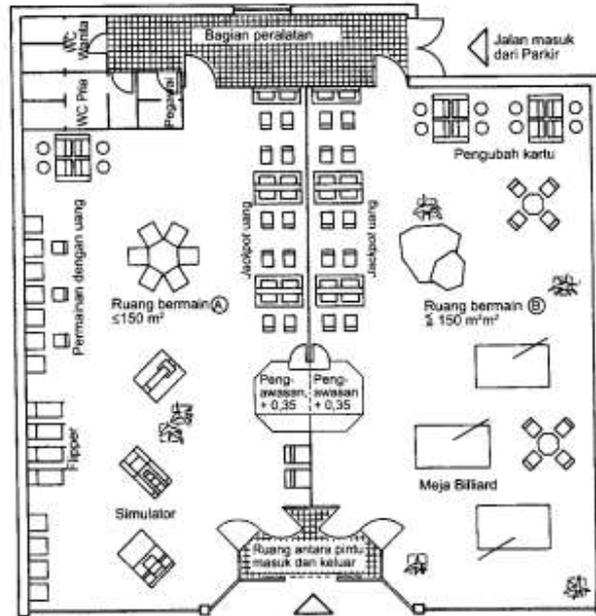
4 Susunan Ruangan Double Rooms
